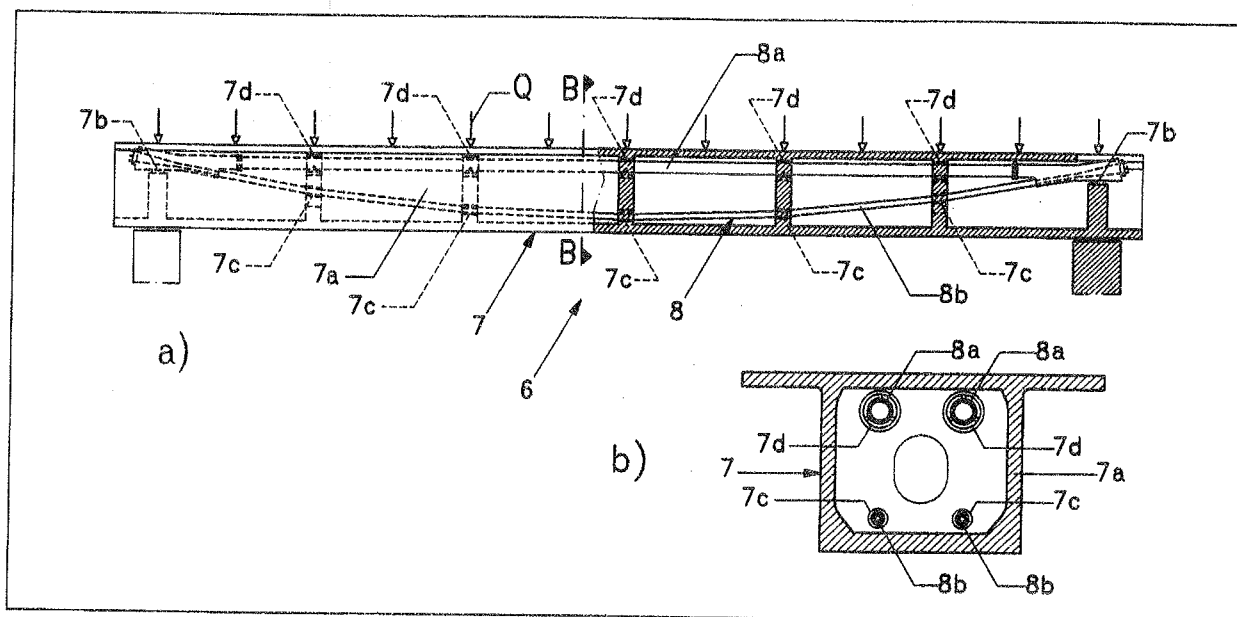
un esempio di SCSSP – a) vista e sezione longitudinale – b) sezione B-B
